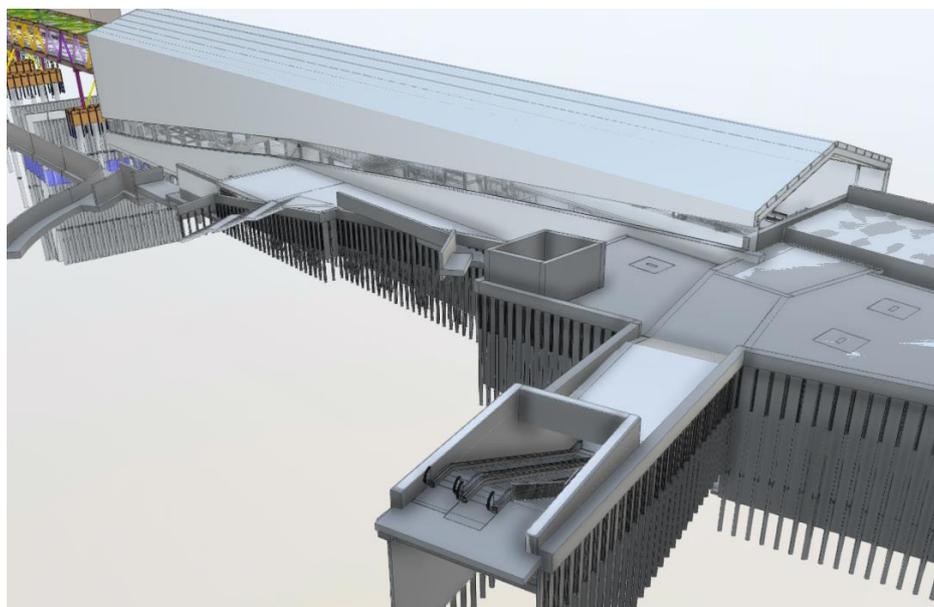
Modelo BIM de arquitetura da Estação Alcântara – lado norte (Estruturas definitivas e de contenção provisória) – Projeto de Execução
